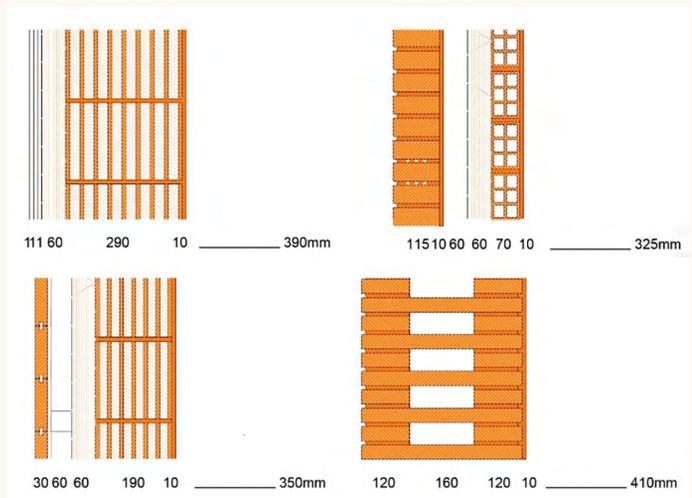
De izquierda a derecha y de arriba abajo: Bloque aligerado y aislamiento por el exterior. Ladrillo visto y cámara de aire ventilada. Aplacado cerámico y cámara de aire ventilada. Dos hojas trabadas. Fuente: elaboración propia.
